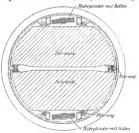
Grundrissanordnung der hydraulischen Aufzüge.
